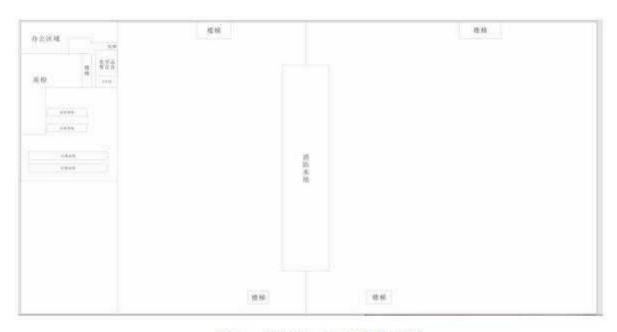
项目厂房 2.3.4 五层平面布置图
